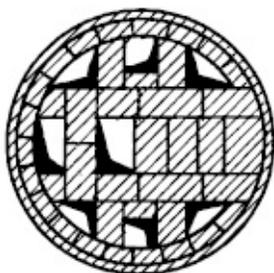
(продолжение). Кладка отопительной круглой печи в металлическом футляре
